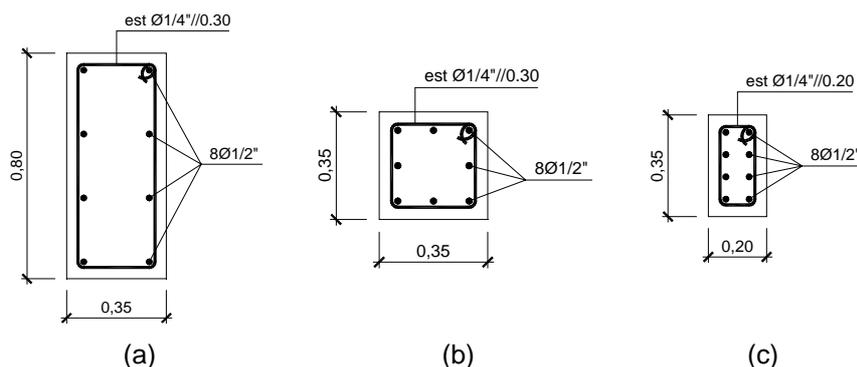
Pormenor de pilar em betão armado, pertencente a um edifício de grande porte.
